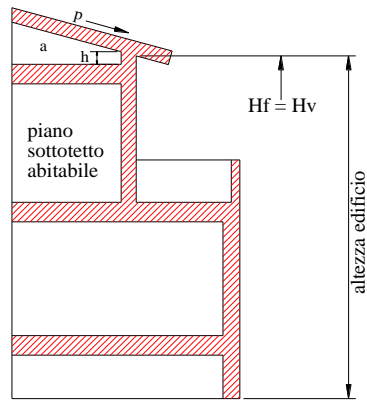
Edificio con attico in arretramento e soffitto piano
